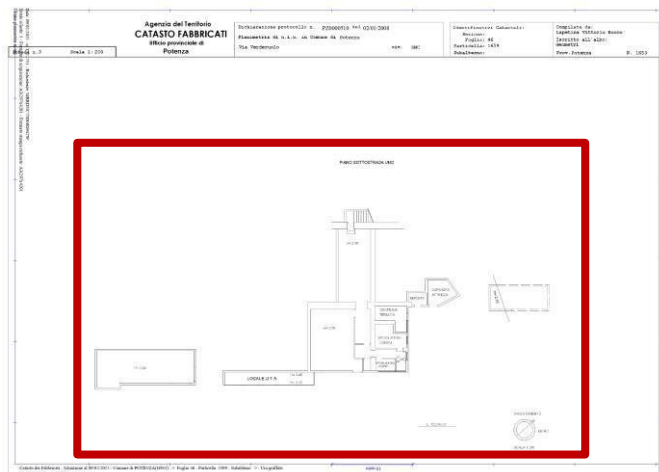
Planimetria Catastale Lotto Lu – Piano Seminterrato (ALL. 06).
